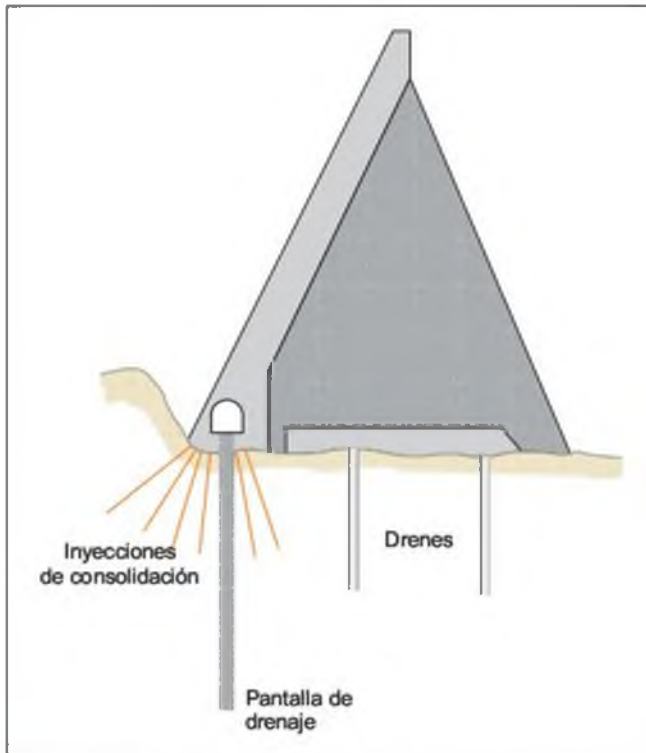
Tratamientos de consolidación y drenaje en una presa de contrafuertes (modificado de Jaoui et al. 1982; en Wylie, 1999).
